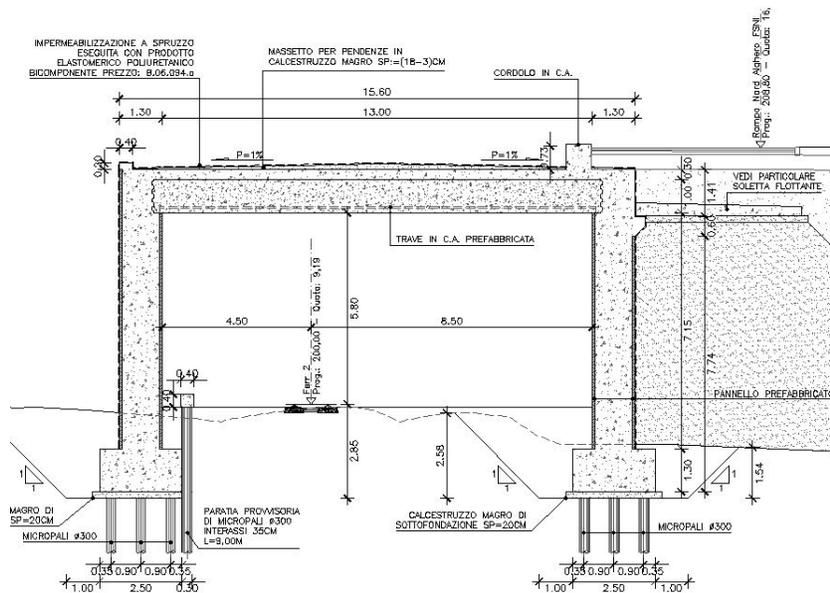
Sezione trasversale - Galleria artificiale ferroviaria "A"
